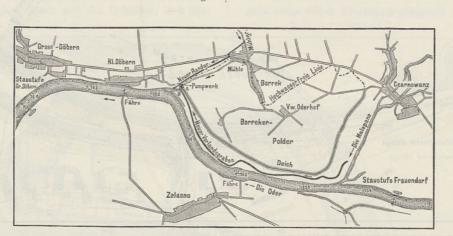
Lageplan der Entwässerung oberhalb Grofs-Döbern.
